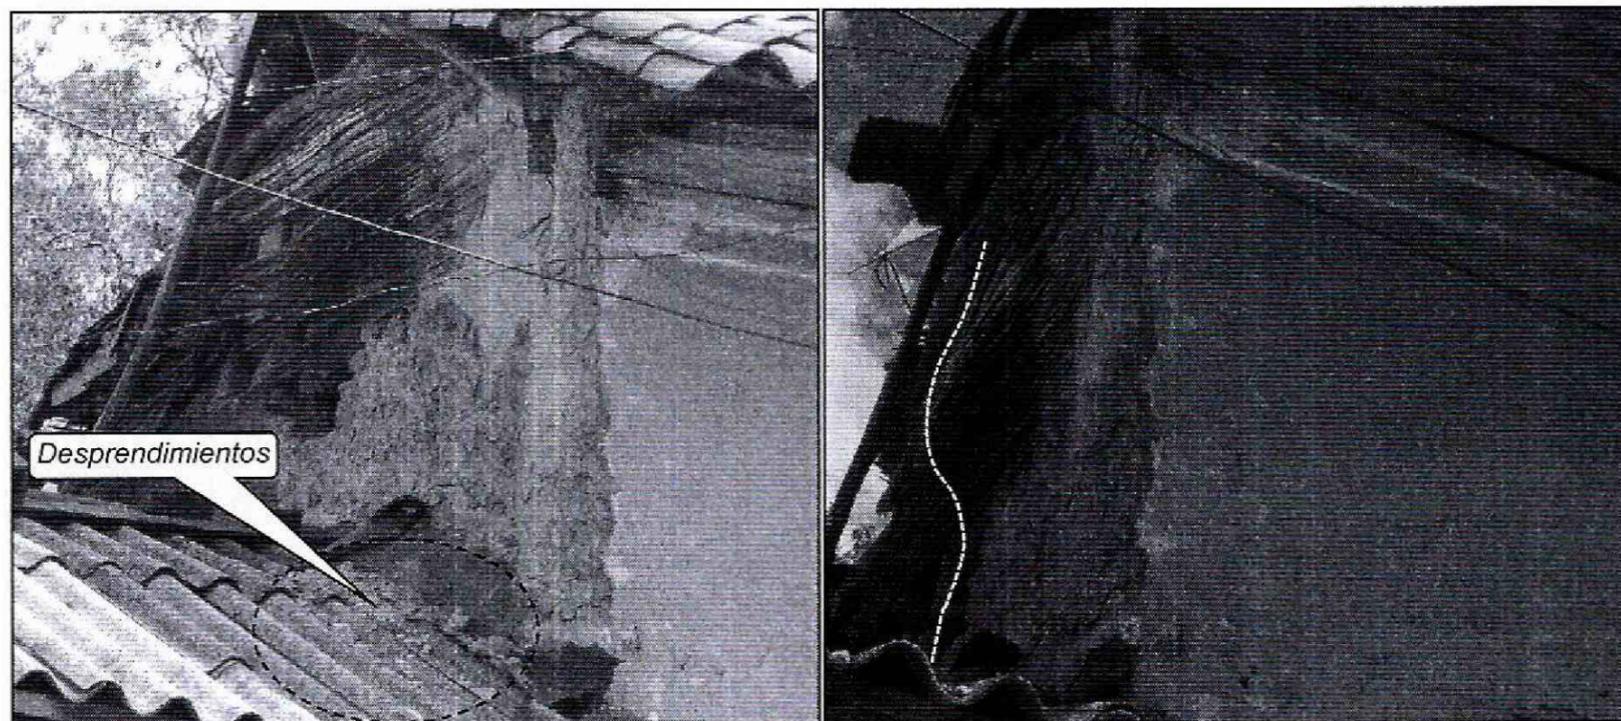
y 6. Vista de las perforaciones realizadas en los muros para el sostenimiento de la cercha metálica de cubierta de la vivienda de la Calle 4 Sur No. 5-50, en el Barrio Las Brisas, de la Localidad de San Cristóbal
